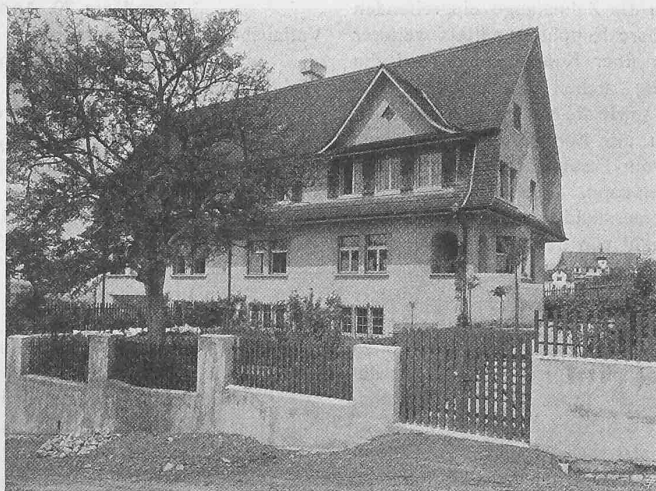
Ansicht von Osten. — Abb. 2 u. 3. Grundrisse vom Erdgeschoss u. Obergeschoss.
